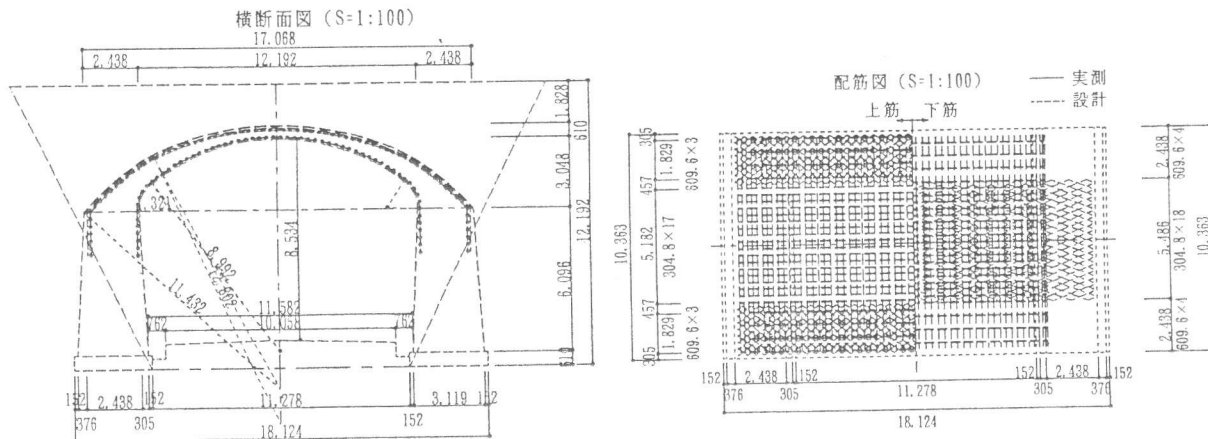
石川橋の横断面図（県庁側）および鉄筋の配筋図
